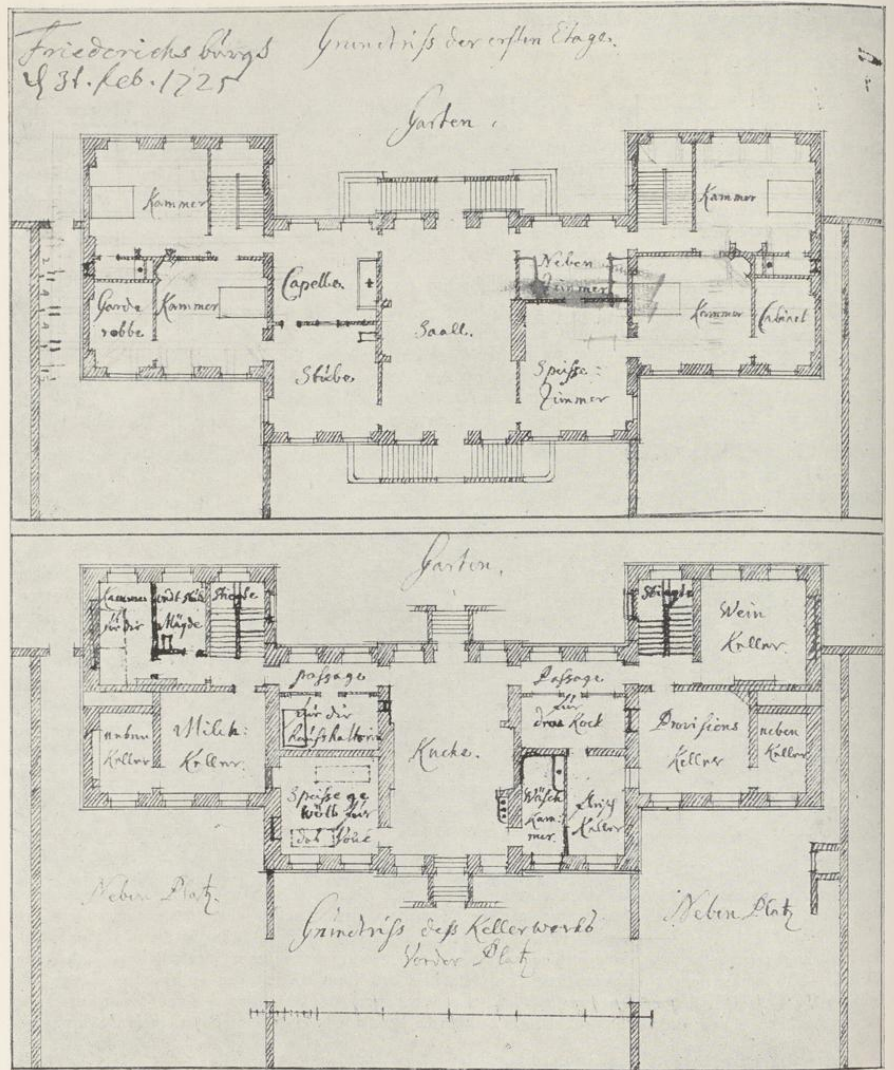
Grundrisse des Keller- und Hauptgeschosses der Friedrichsburg
